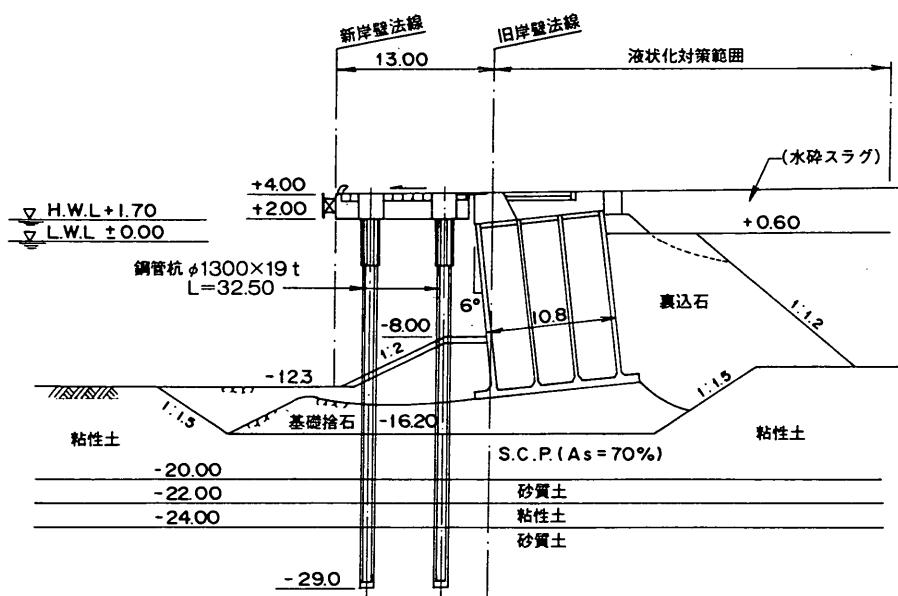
神戸港摩耶埠頭岸壁(-12m)復旧断面図
